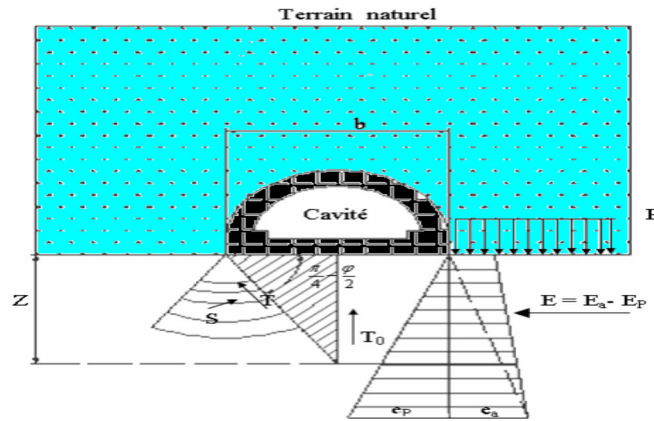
La poussée au niveau de radier selon TSIMBRIEVITCH
